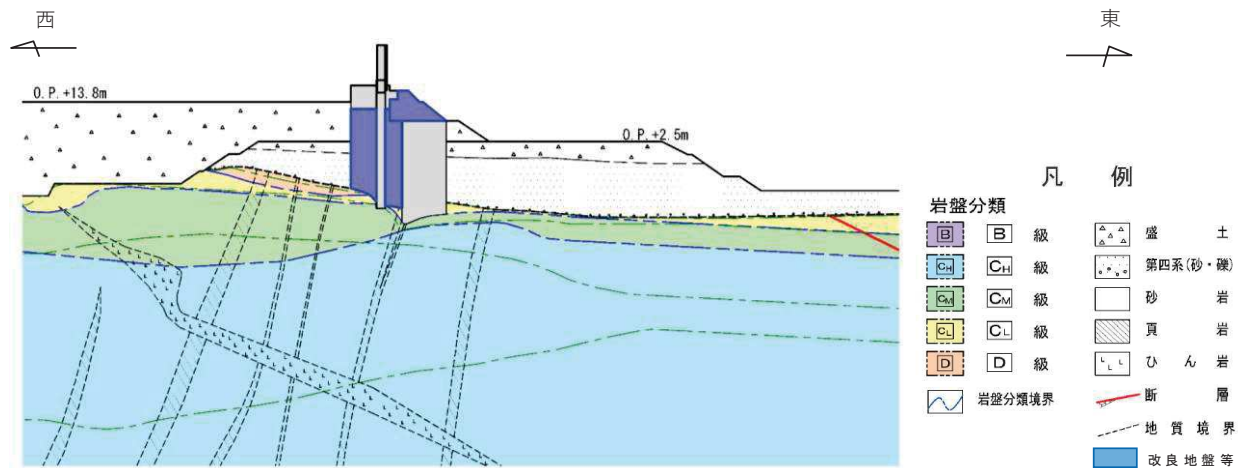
鋼管式鉛直壁（一般部）I-②断面（断面②）
